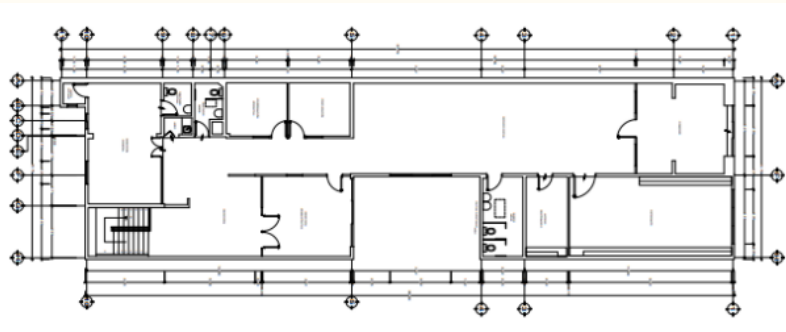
Primera planta arquitectónica en AutoCAD del estado actual sin amueblar.
